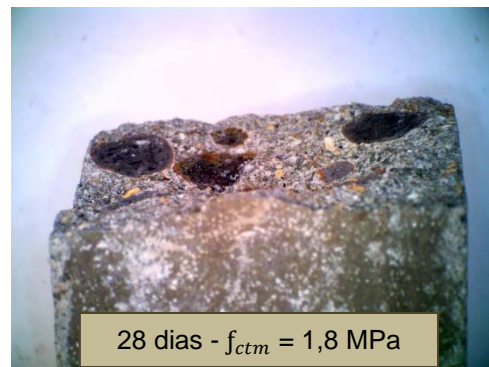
Superfície de fractura de provete com Leca inicialmente seca ensaiado à tracção axial (fractura através do agregado)
